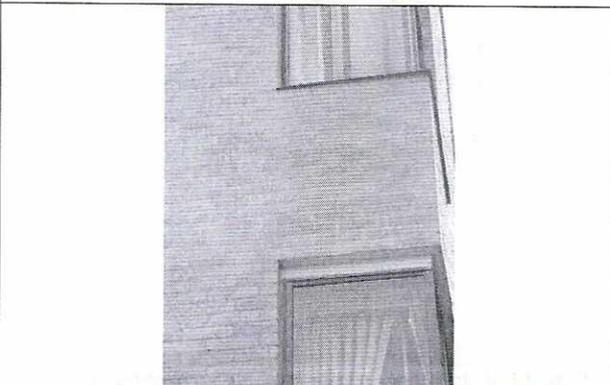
Fachada lateral costado suroriental. Se aprecia inclinación del bloque 58. Agrietamiento muros
